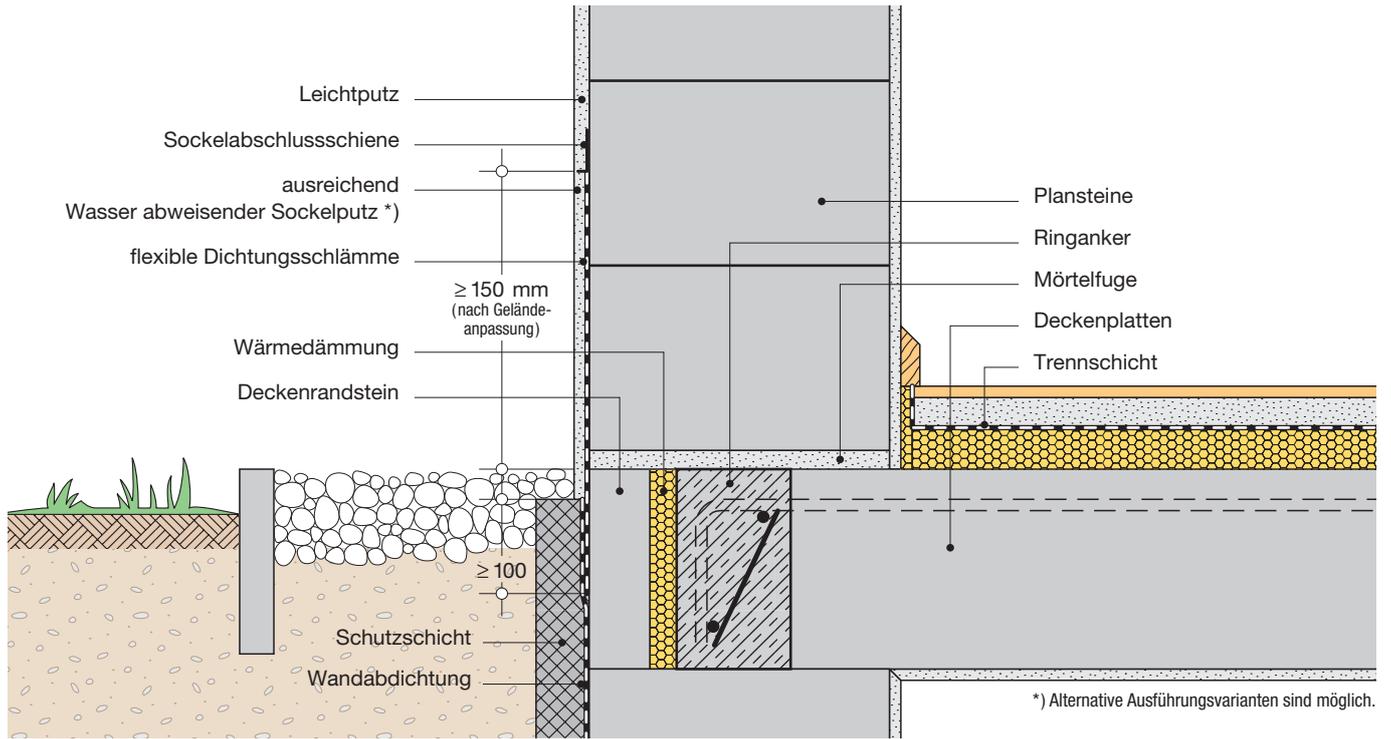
Sockelausbildung bei einschaligem Kellermauerwerk aus Porenbeton
